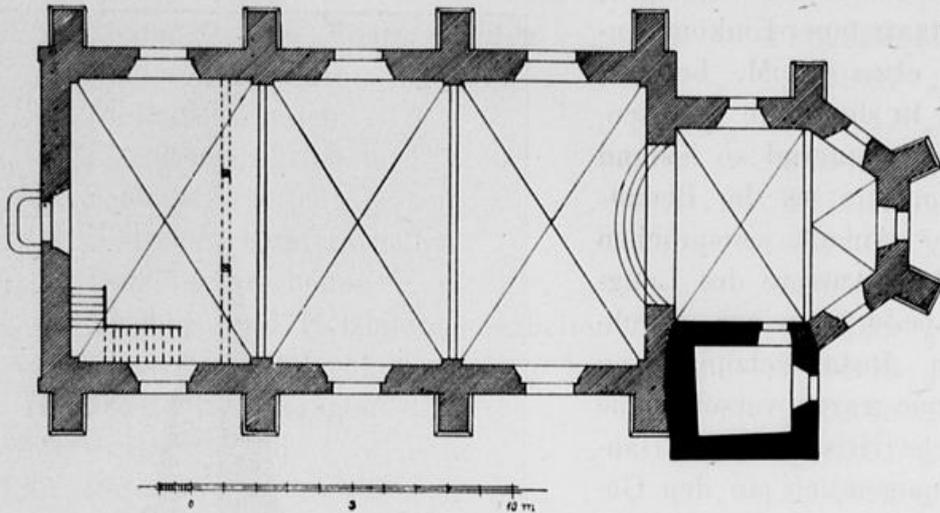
Schleidweiler. Kath. Pfarrkirche. Grundriss.
